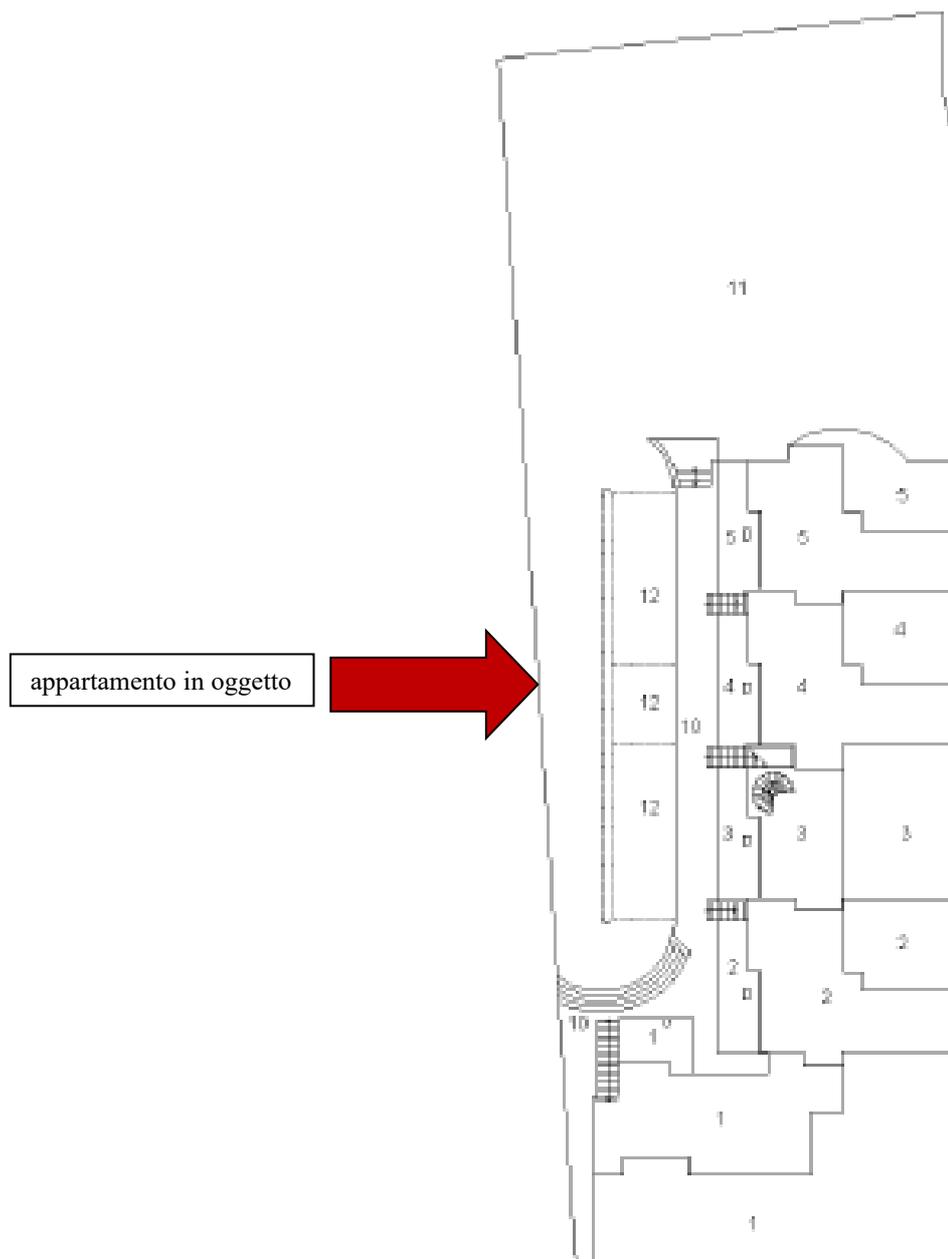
Planimetria del lotto – concessione edilizia 65/2005 del 08/11/2005
